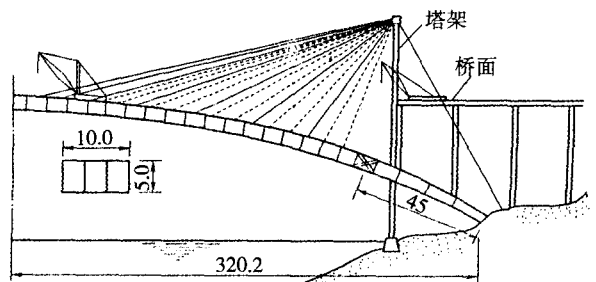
拱桥塔架斜拉扣挂悬臂施工图（尺寸单位：m）
